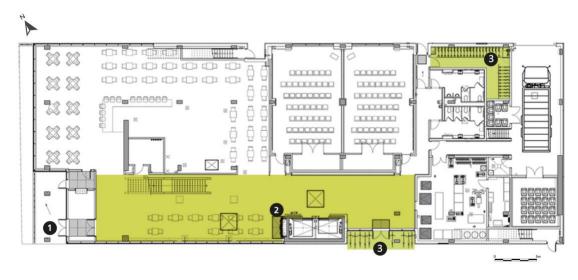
Plan du parc d'Hydro-Québec : Rez-de-chaussée (CCxA, s.d).
